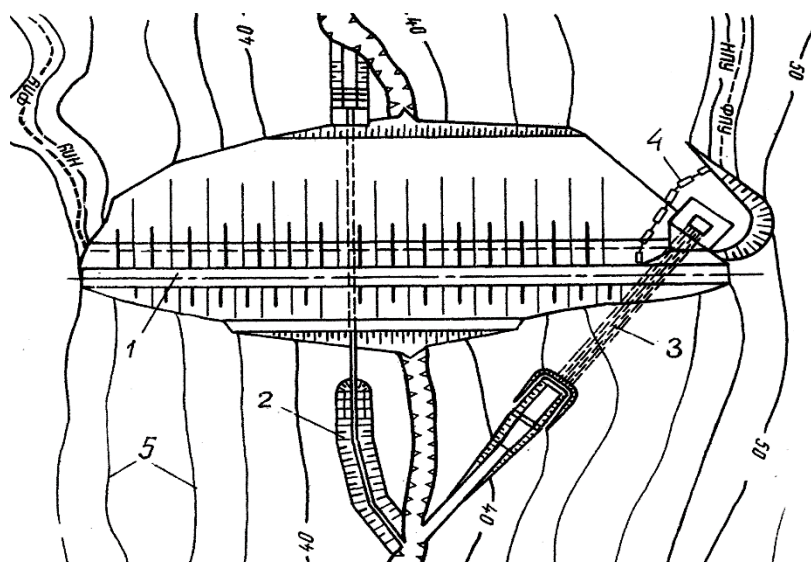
Гидроузел с грунтовой плотиной:
